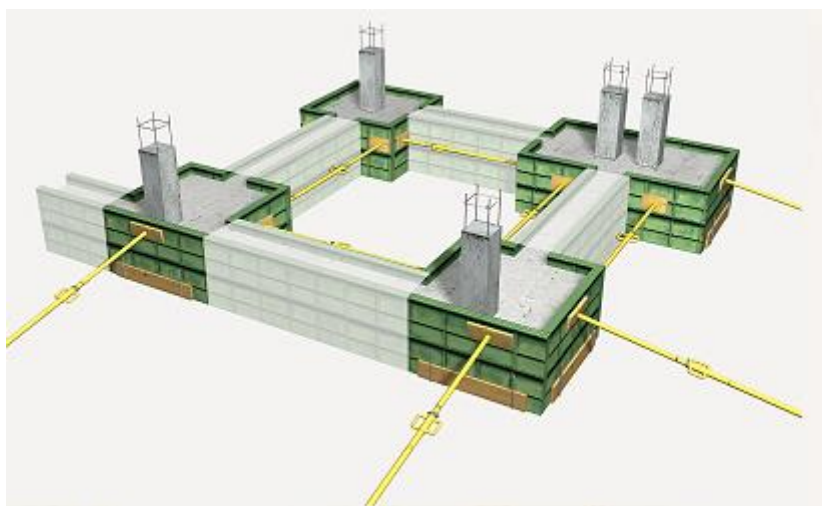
Sistema de encofrado (tipo metálico) para zapata de cimentación
